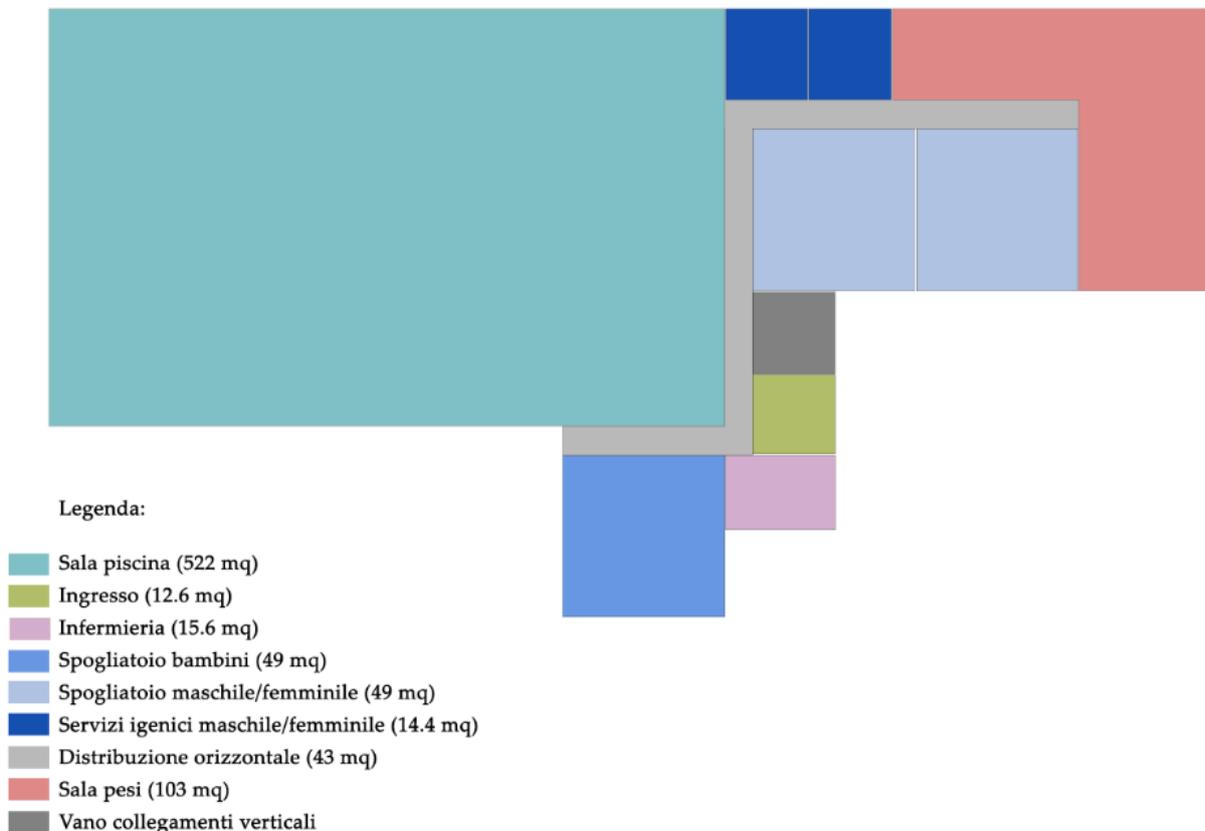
Legenda e planimetria del piano terra del complesso sportivo.
